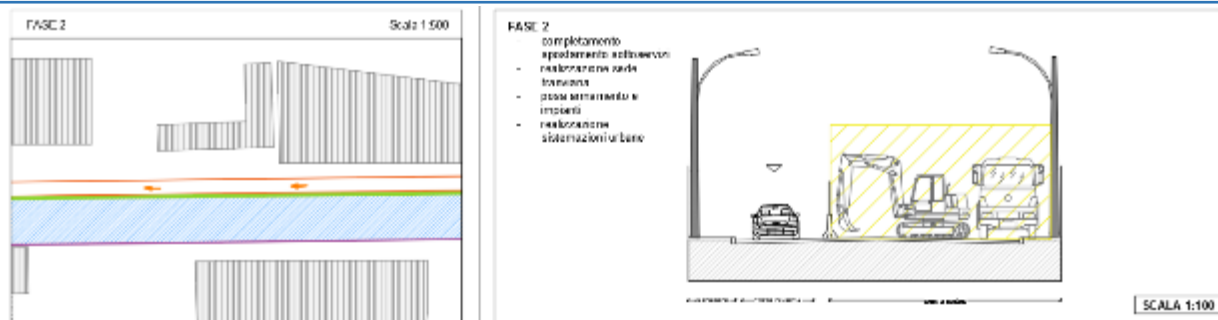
Tipologico cantiere con sede laterale Fase 2
